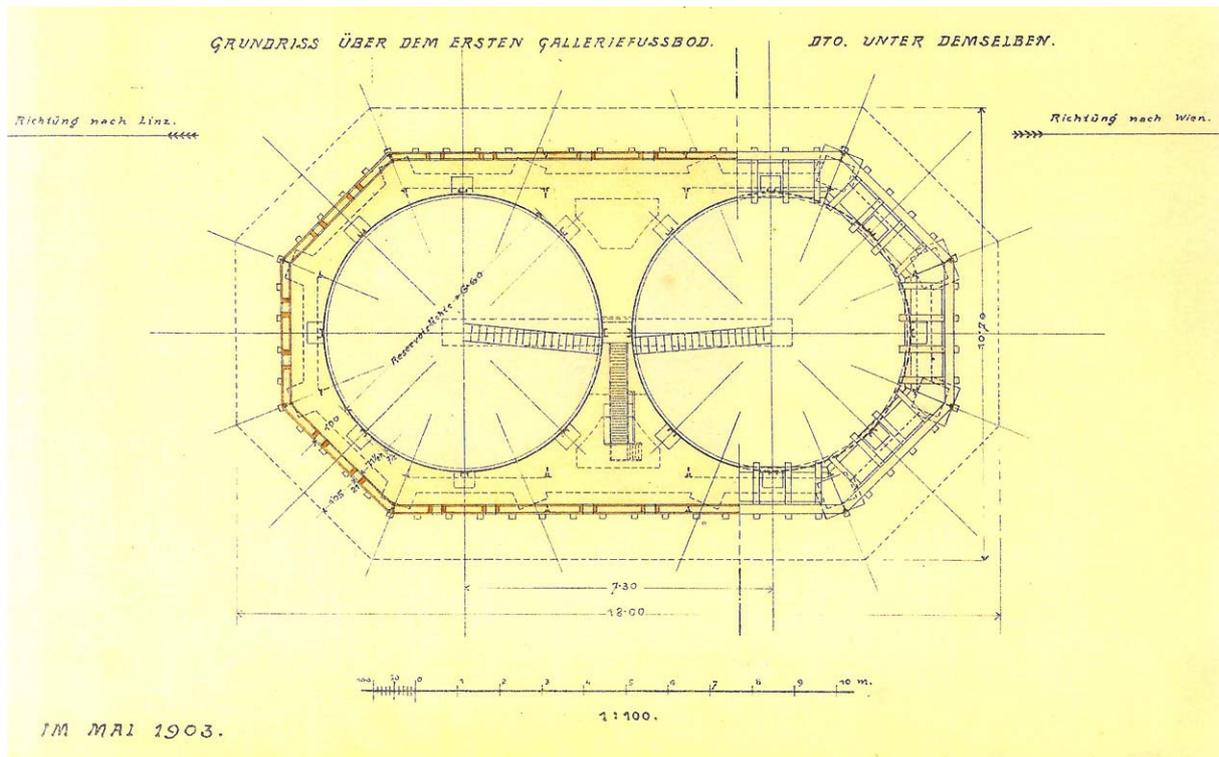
Grundriss Galerie, Plan Mai 1903
